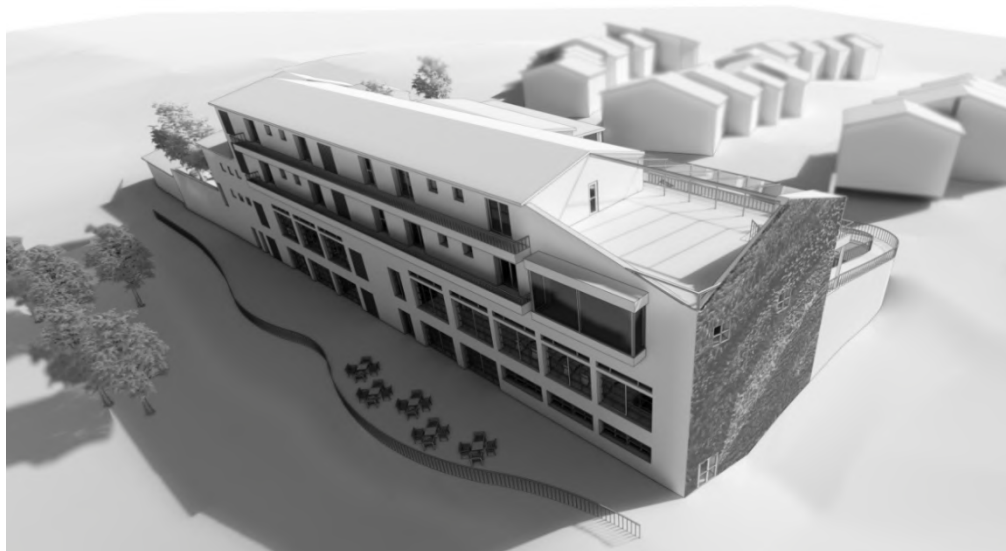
Perspetiva do conjunto edificado com a proposta de Reabilitação - vista Noroeste.
